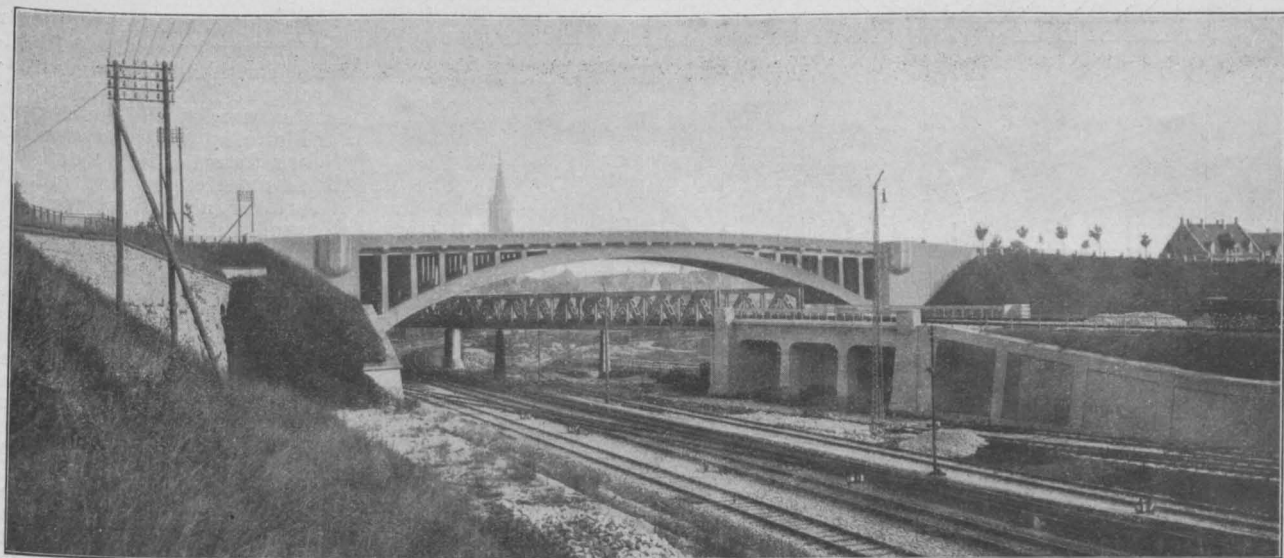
Kreuzung des Wallgrabens im Ulmer Bahnhof mit Eisenbetonbrücke. (Oben die Wallstraßenbrücke, vergl. 1907 No. 1.)
